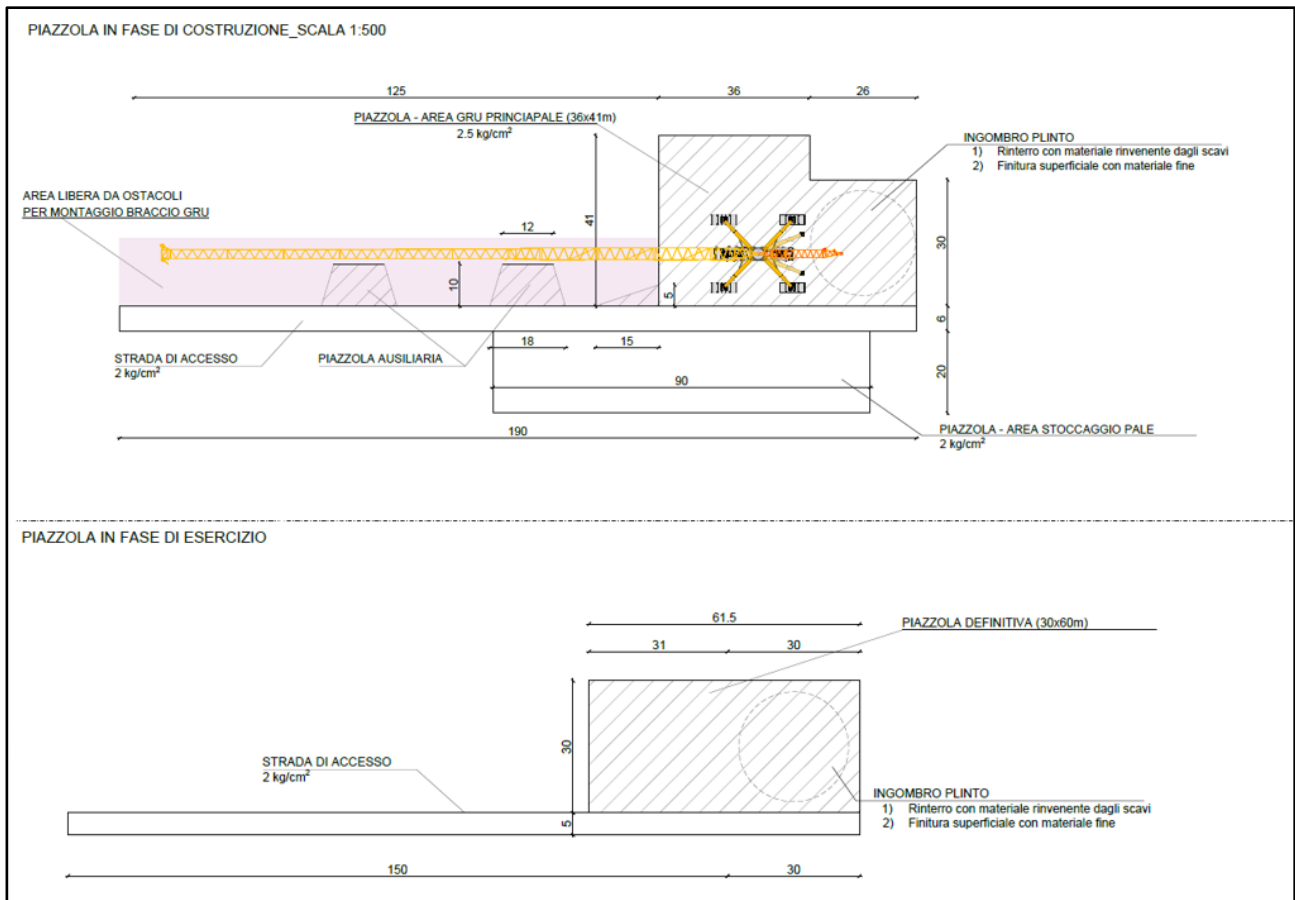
Planimetria piazzola tipo per la fase di installazione e fase di esercizio e manutenzione
